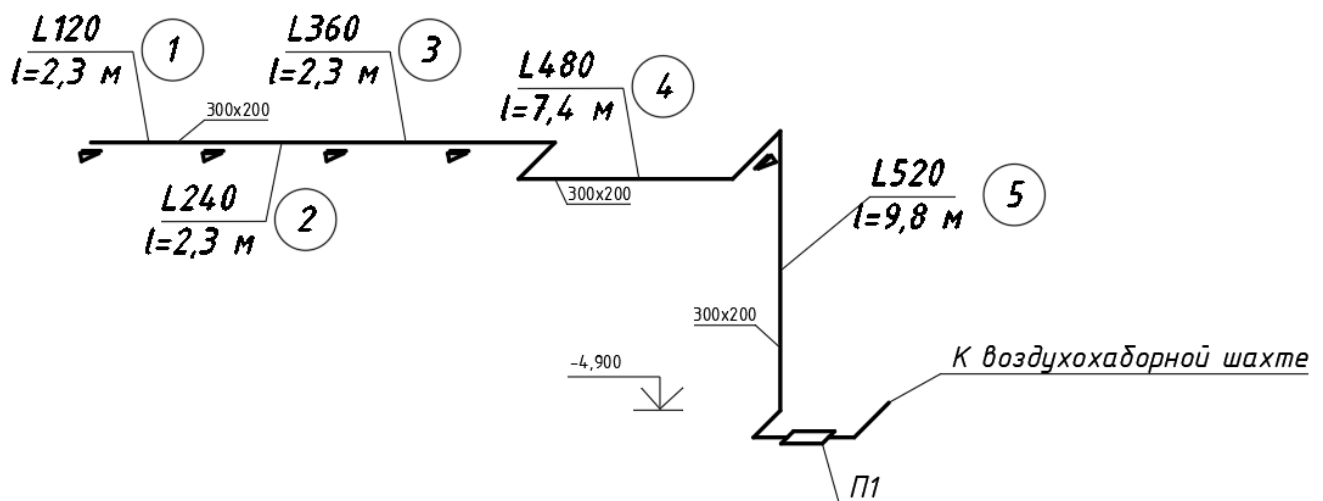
Расчетная схема вентиляционной системы П1
